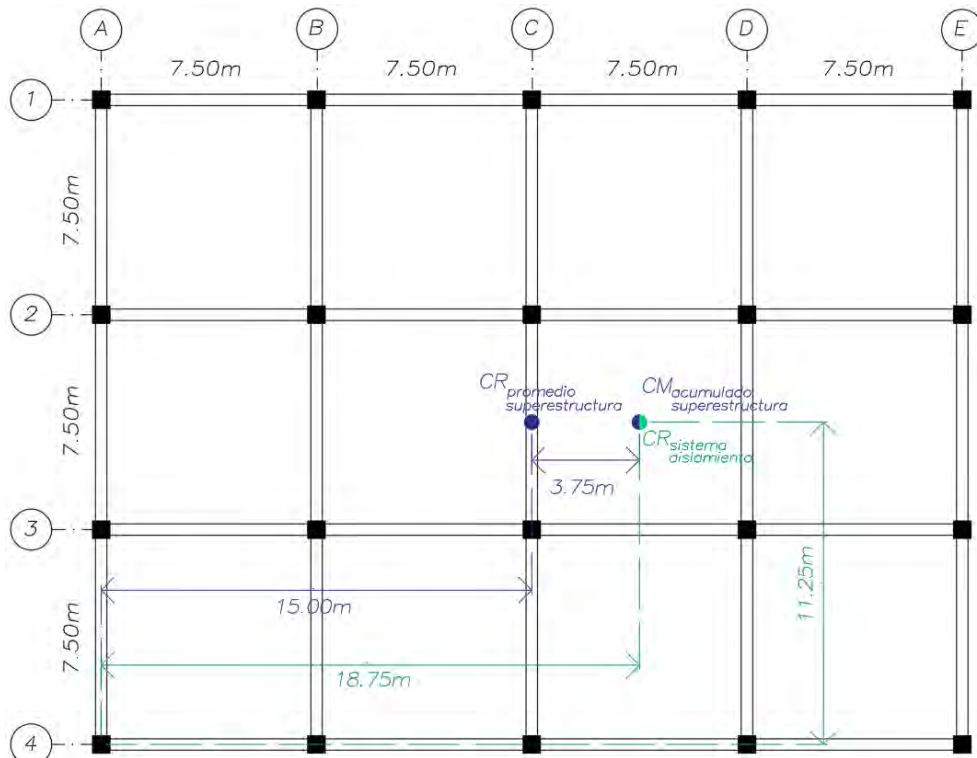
Ubicación del CR del sistema de aislamiento en el CM acumulado de la superestructura.
